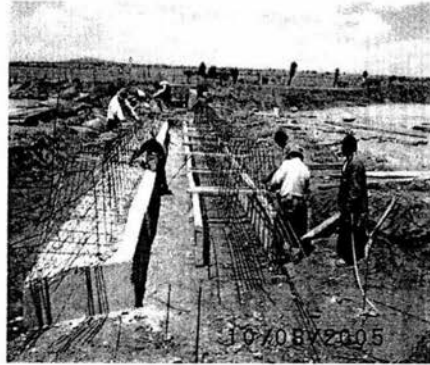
Trabajos de cimbrado de zapata para alcantarilla en el kilómetro 144+875
